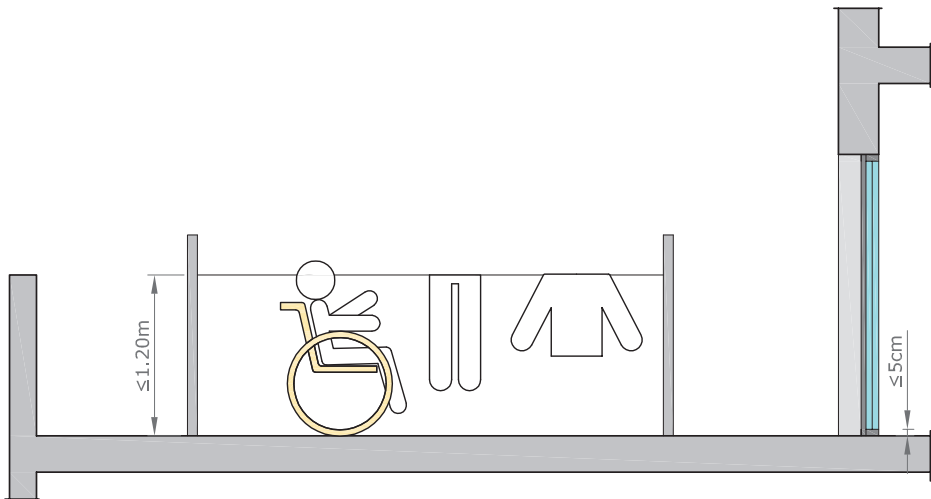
Detalle acceso a terraza y colocación del tendedero.
